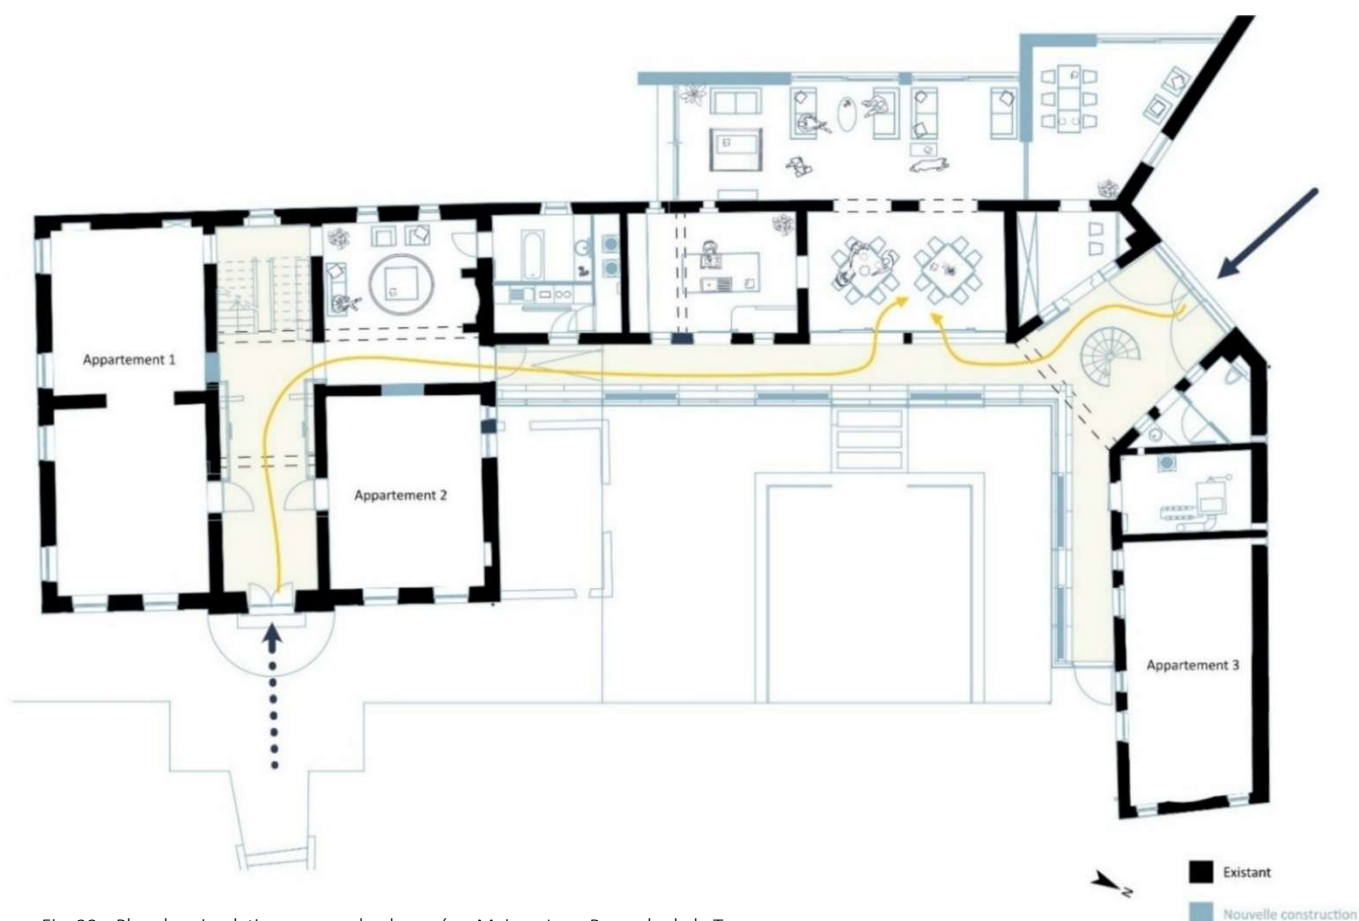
Plan des circulations au rez-de-chaussée - Maison Jean-Remacle de la Tour
